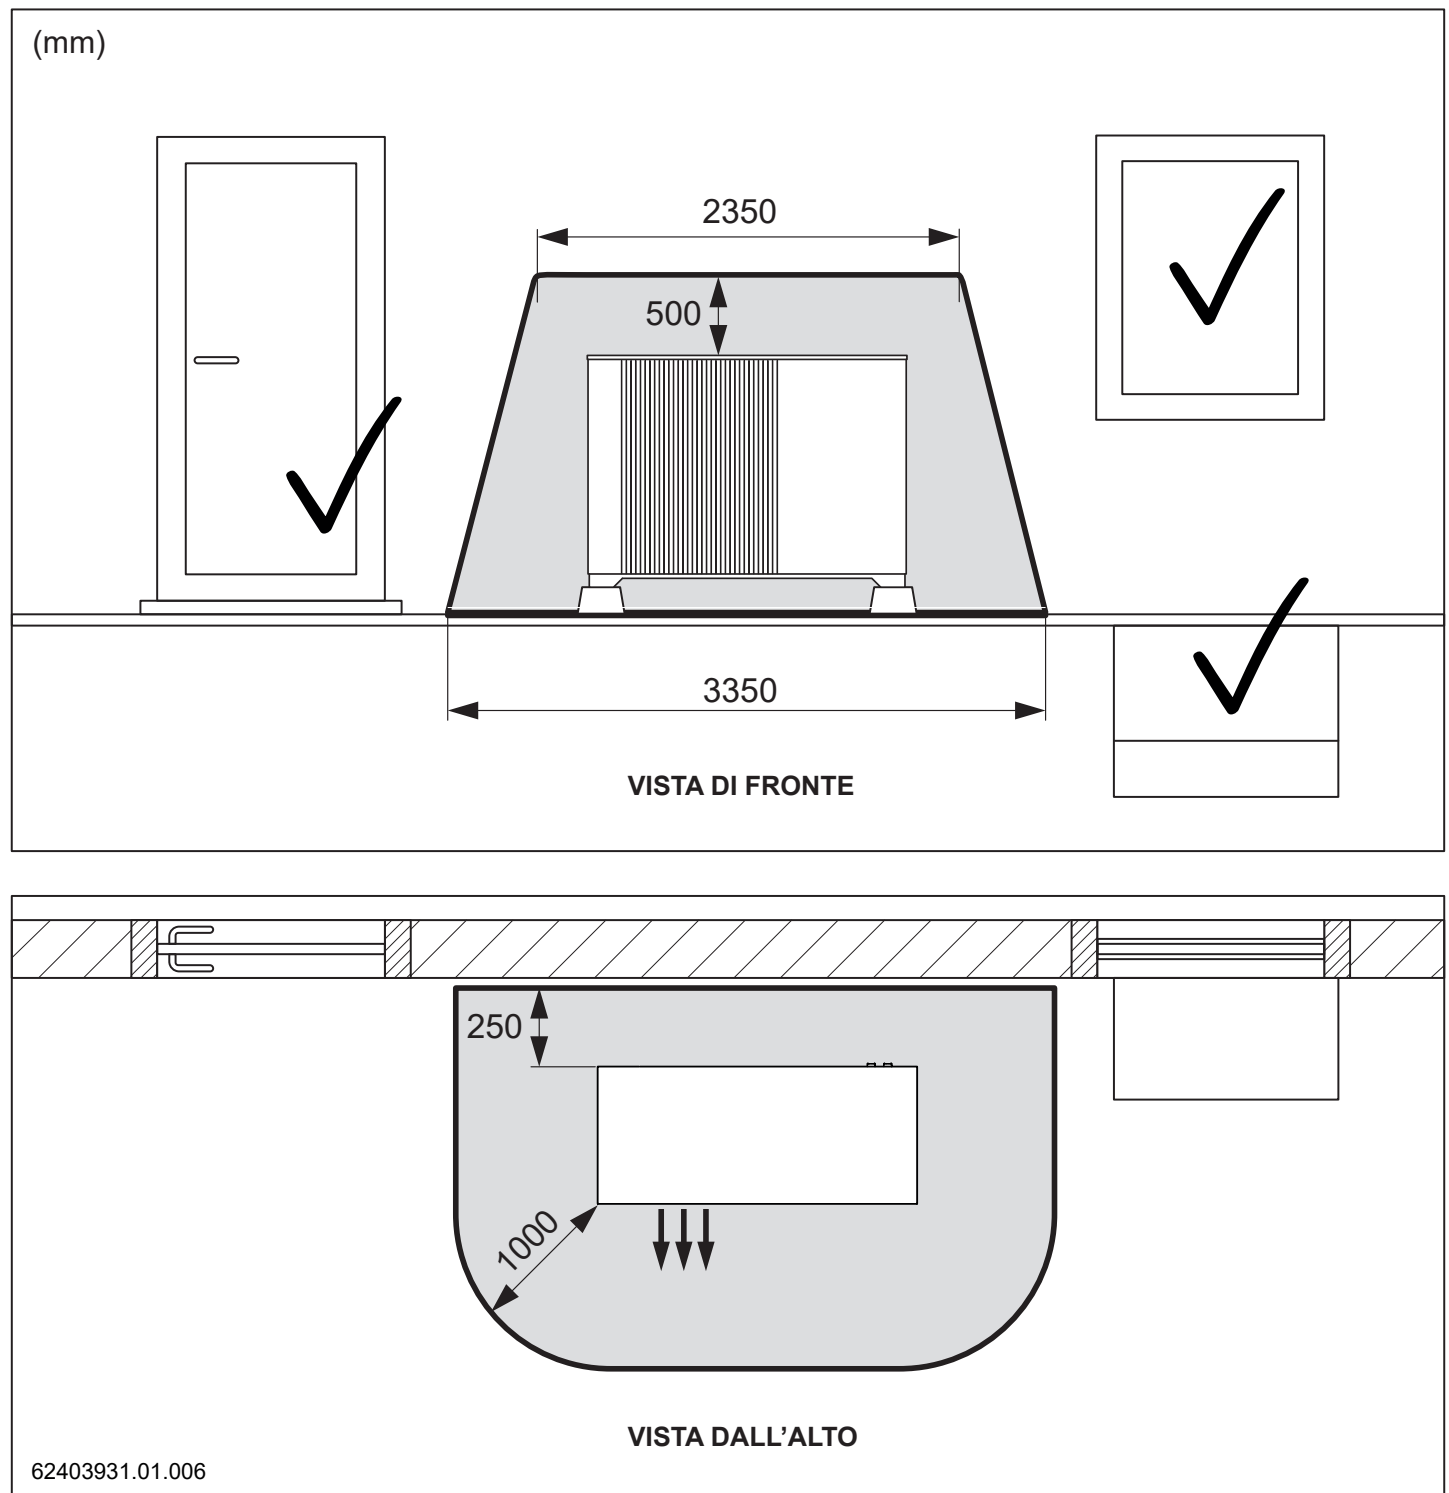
Installazione a terra davanti a una parete (misure in mm)
